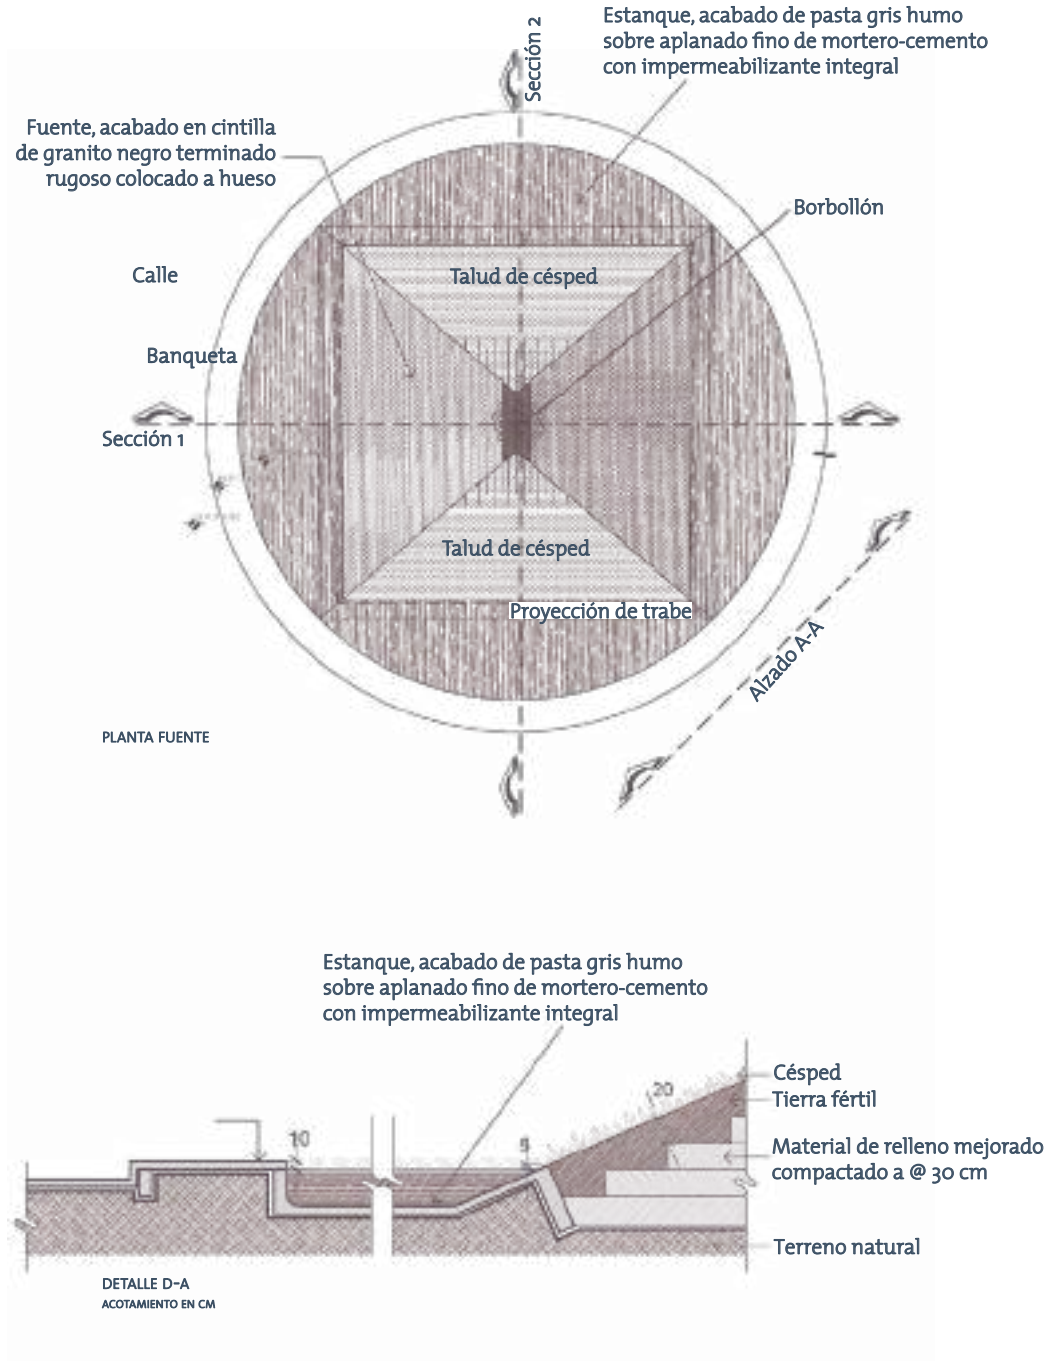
Detalles de fuente, corporativo Cemex, Monterrey, Nuevo León
